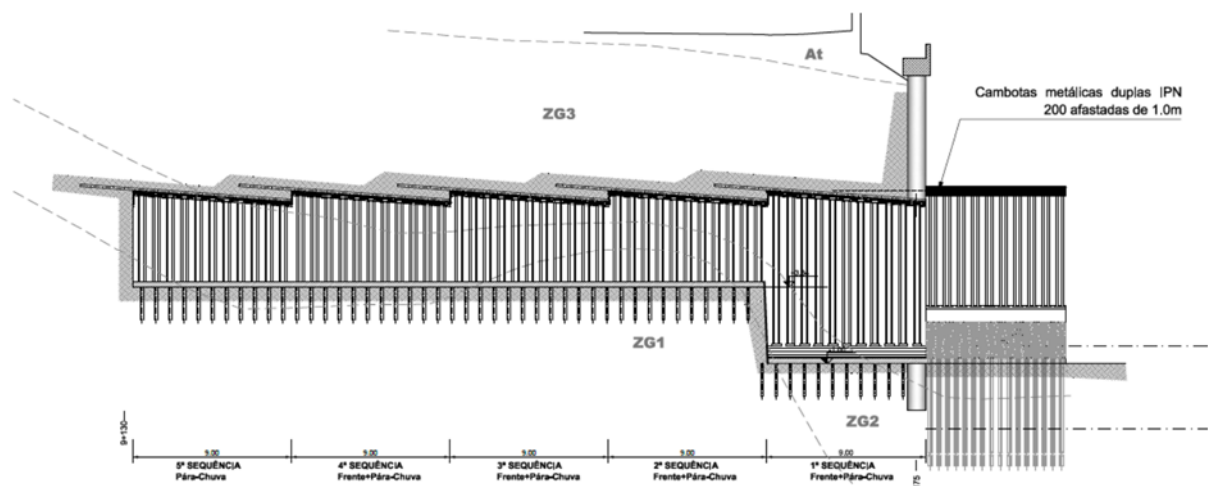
Fase 4 – escavação da calote inferior em ZG3emb
